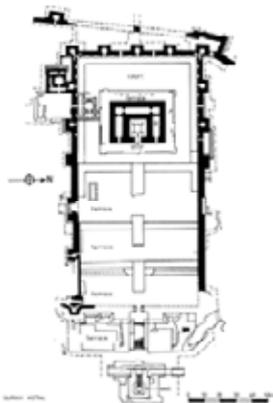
Grundriss Surkh Kotal (Quelle: Ball, 1982, Karte 53)
